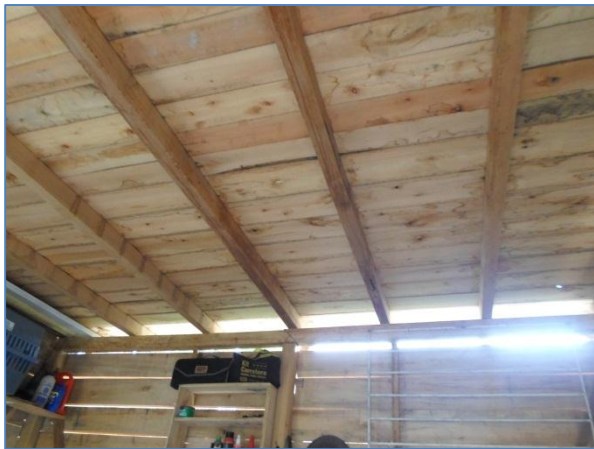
Vigas aéreas vivienda en madera dos plantas.
